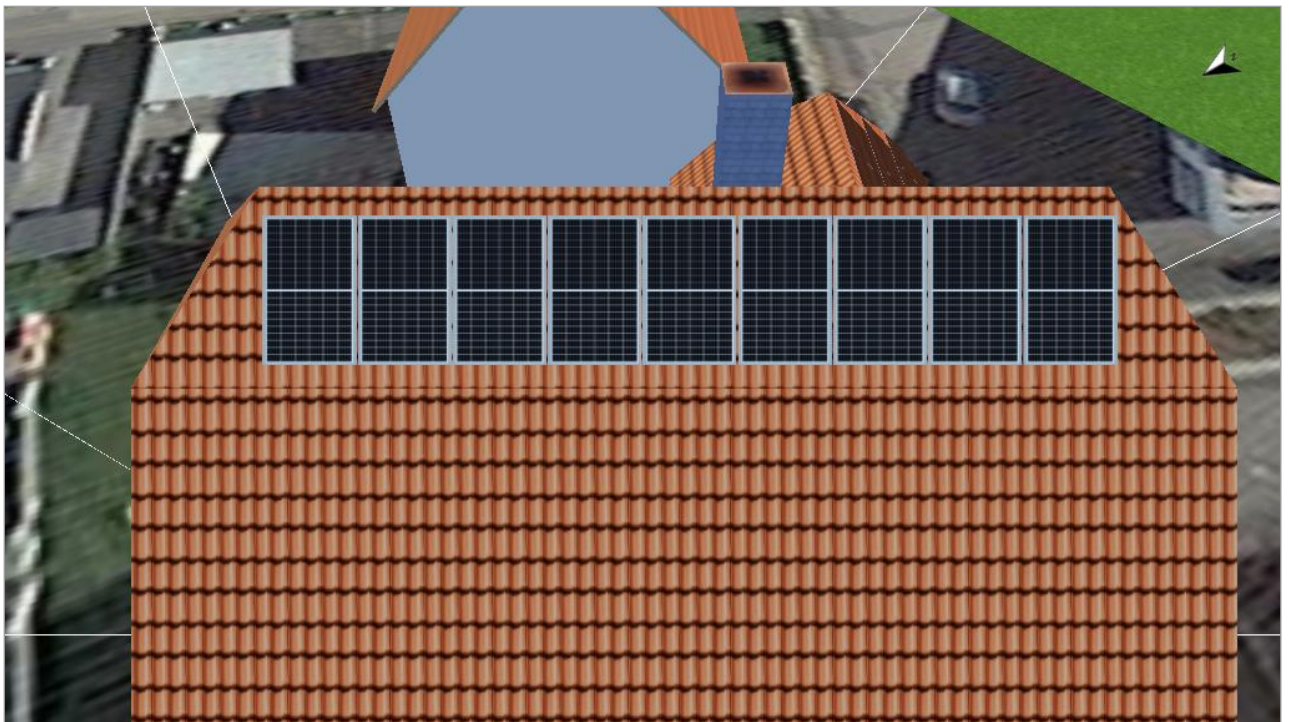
Modulfläche - Gebäude 01-Dachgeschoss2-Dachfläche Nordwest
